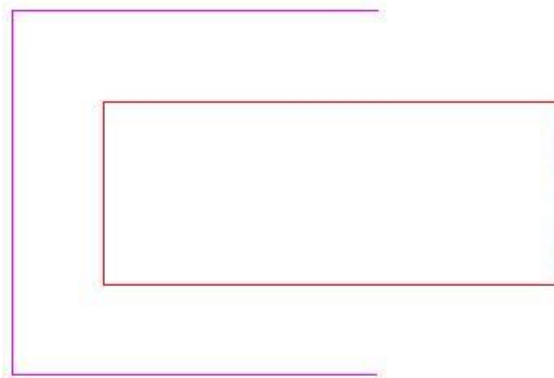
Расчетный контур при продавливании краем стены без учета края плиты
